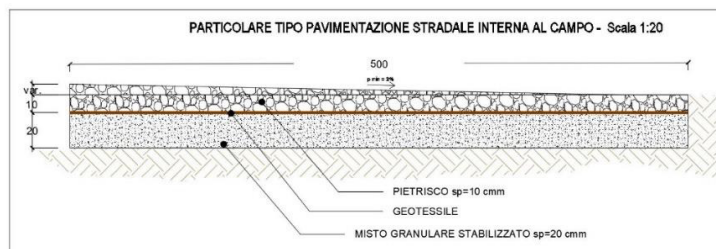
Particolare tipo pavimentazione delle viabilità di servizio interne.
